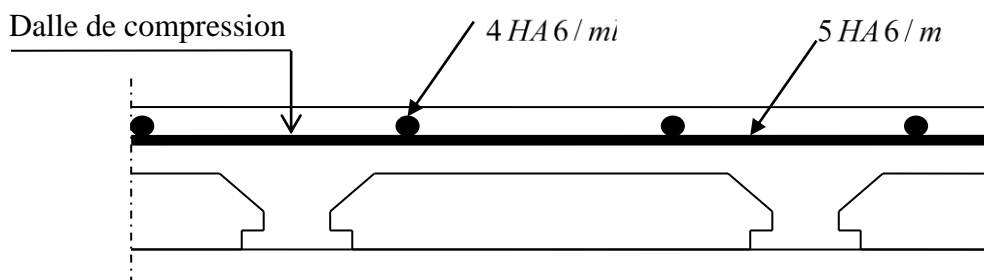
Schéma de ferrailage de la dalle de compression.
